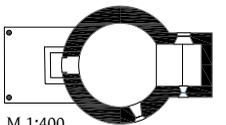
Grundriss CA 2015. M 1:400.
